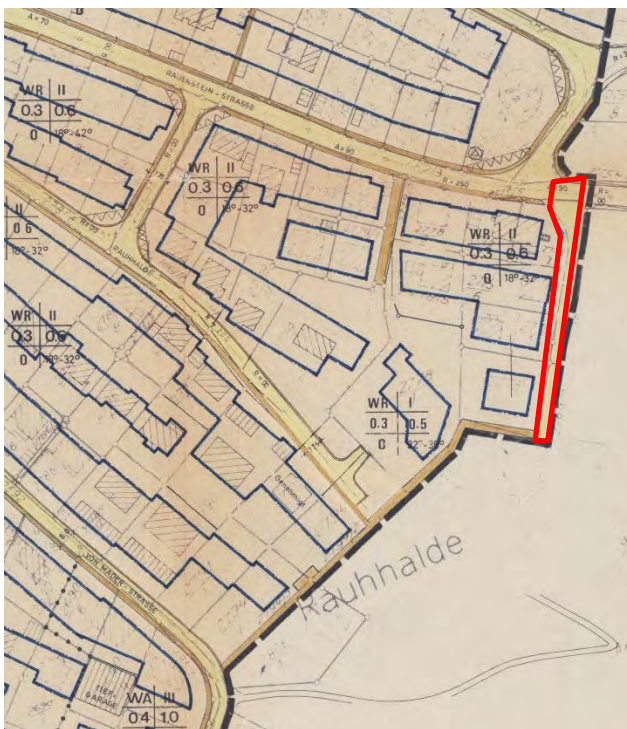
Bauungsplan „St. Ulrich-Rauhhalde“, Überlagerung Geltungsbereich Neuaufstellung (rote Umgrenzung)
